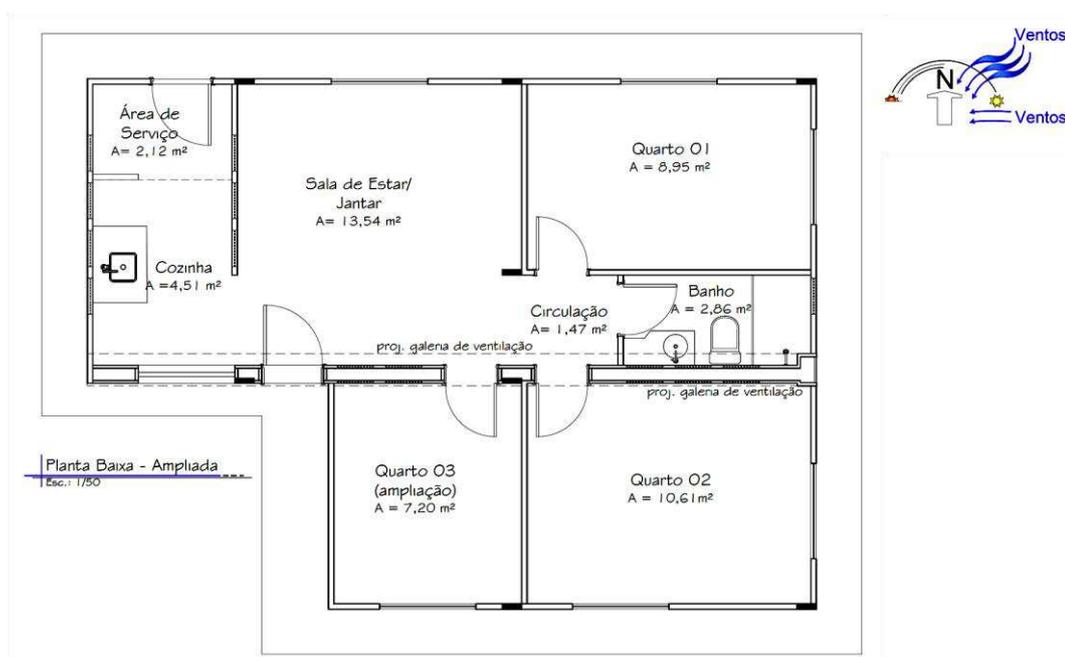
Proposta Projeto Modelo de Habitação - Planta Baixa Ampliada.
